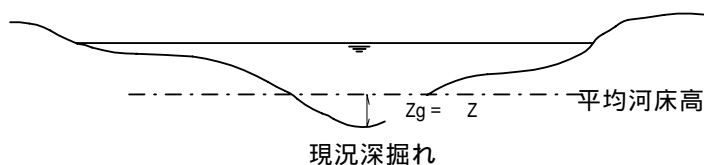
現況深掘れ部と最大洗掘深の断面説明図
